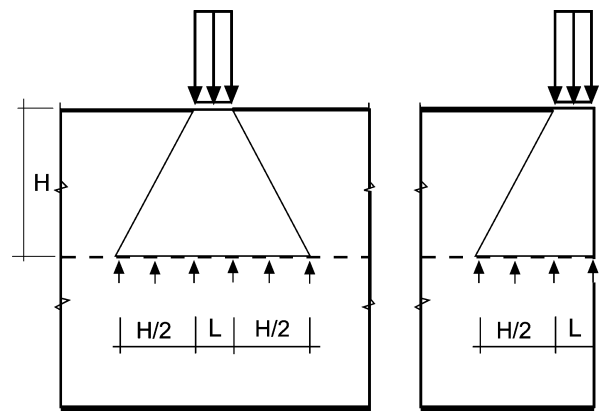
Apoyo de cargas puntuales. Reparto de cargas sobre el muro.
